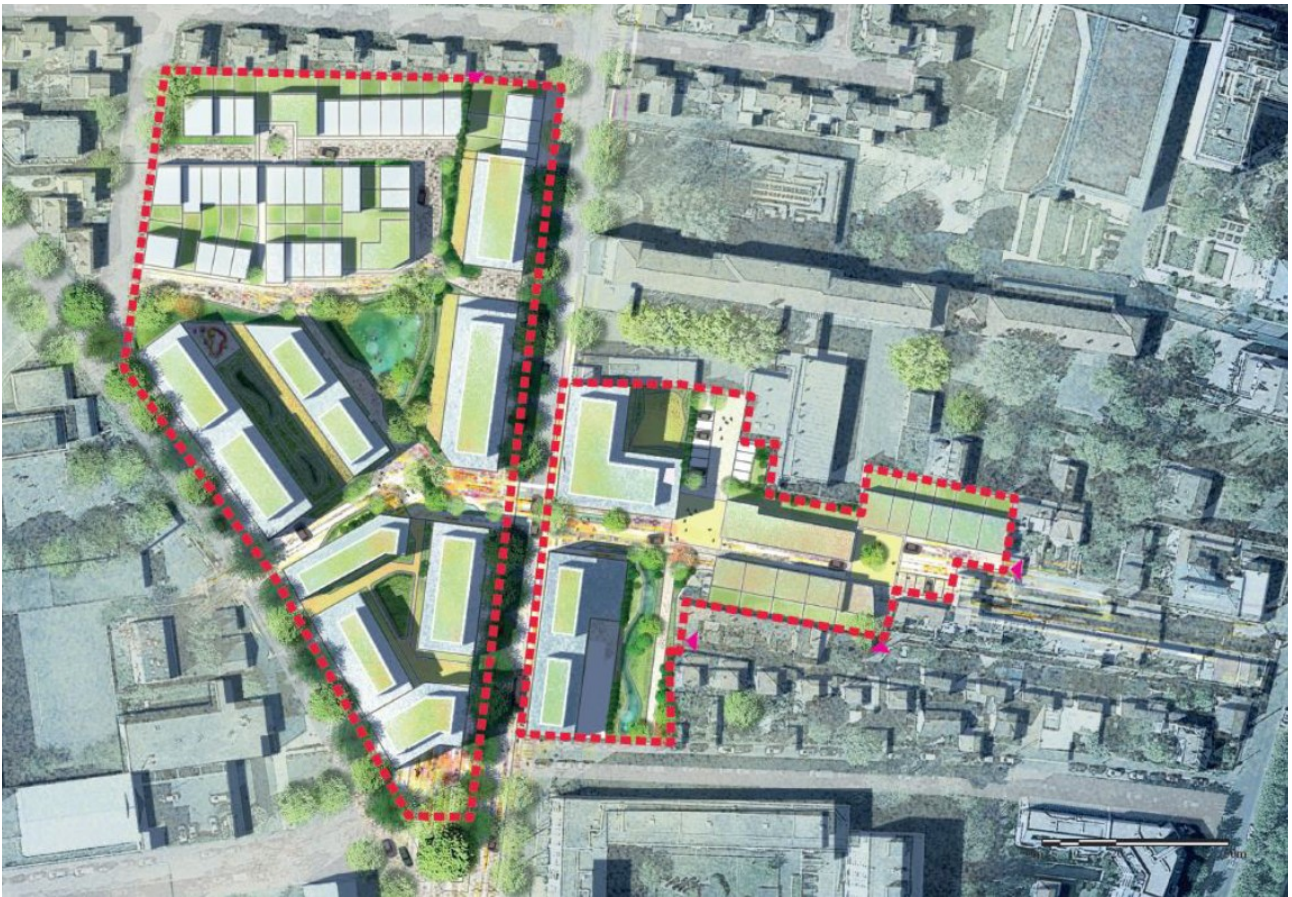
Plan masse du projet (source : étude d'impact - page 22)
